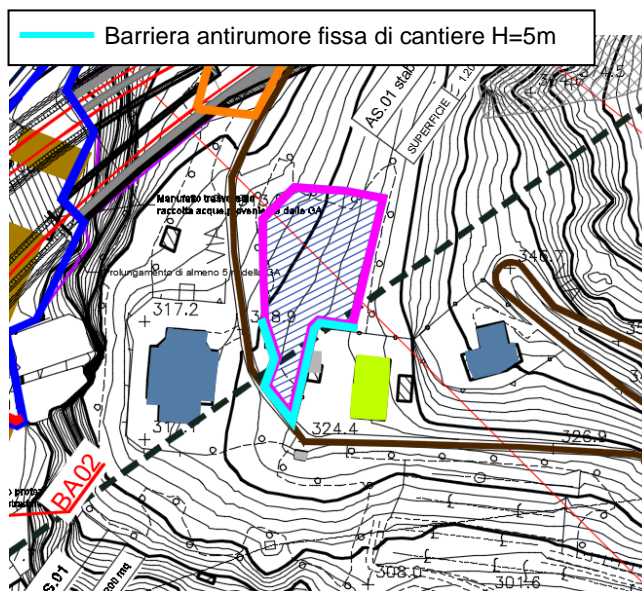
Localizzazione della barriera antirumore di cantiere BA06
